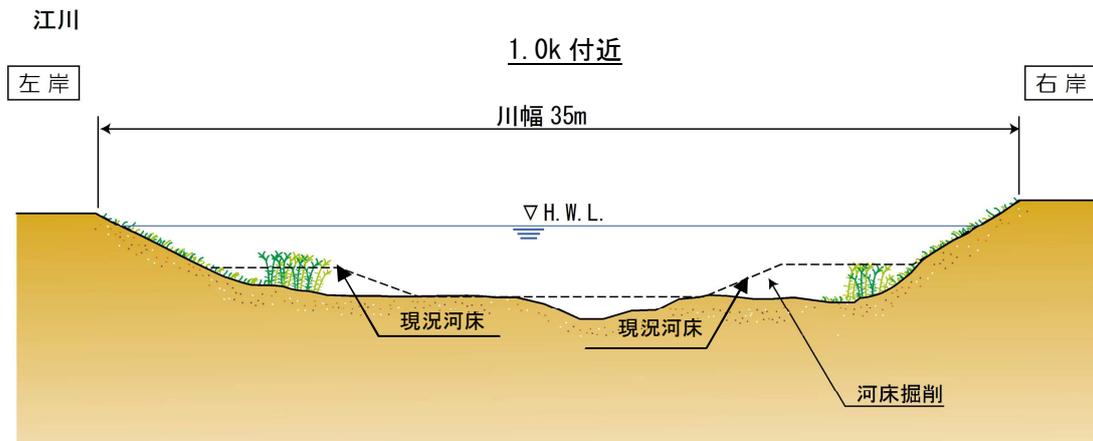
江川における代表地点（暫定改修済み区間）の横断面図
